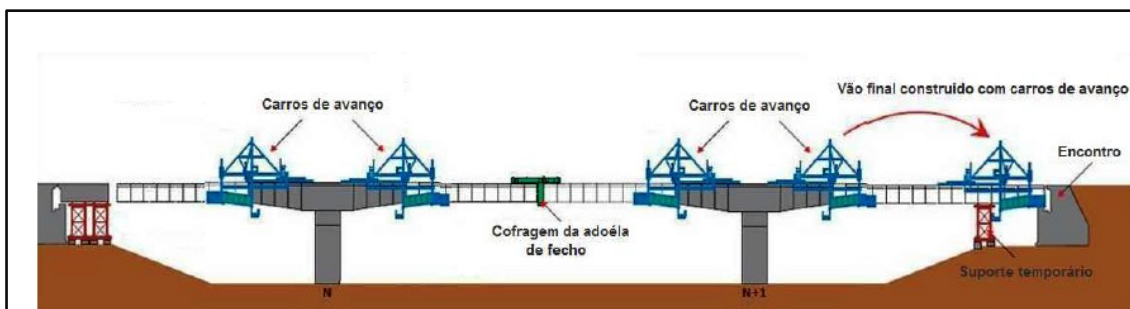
Construção do tabuleiro de uma ponte com recurso a carros de avanço
